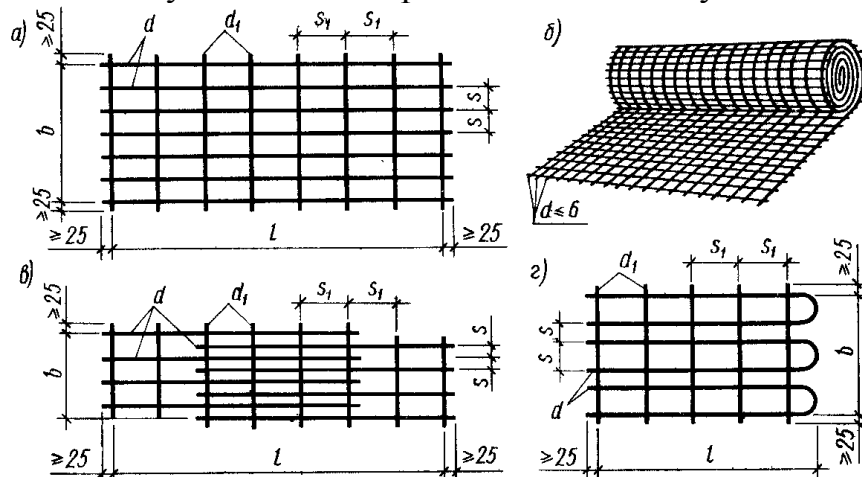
Арматурные сетки: а) стандартная плоская; б) рулонная; в) нестандартная с рабочими стержнями не доходящими до конца; г) нестандартная с петлями на конце
